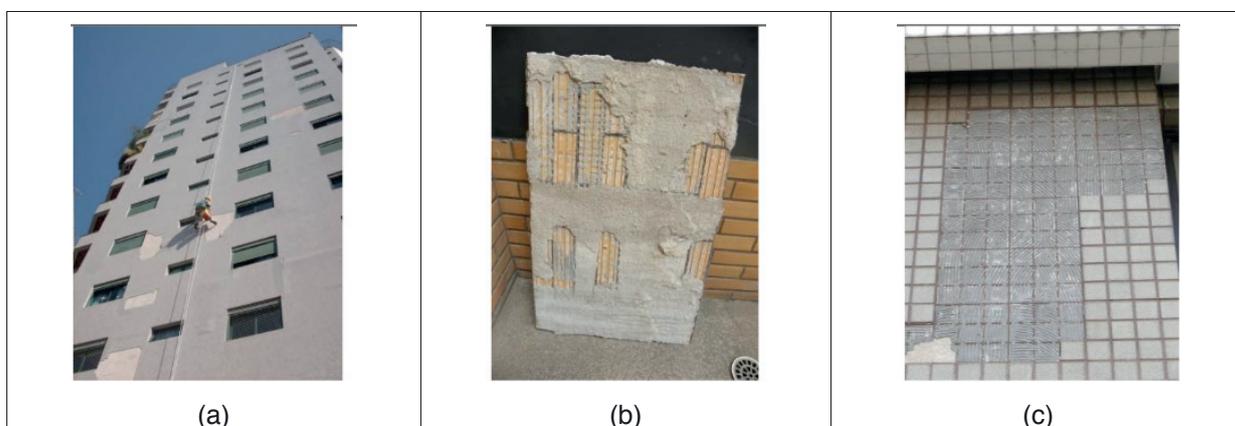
(a) Vista geral da fachada do edifício “JA” com áreas de descolamento; (b) vista detalhada do tardo de placas cerâmicas descoladas de fachada do edifício “H” evidenciado por falhas de assentamento; (c) vista detalhada de trecho de fachada do edifício “I” com descolamento de revestimento cerâmico, evidenciado por falhas de assentamento.
